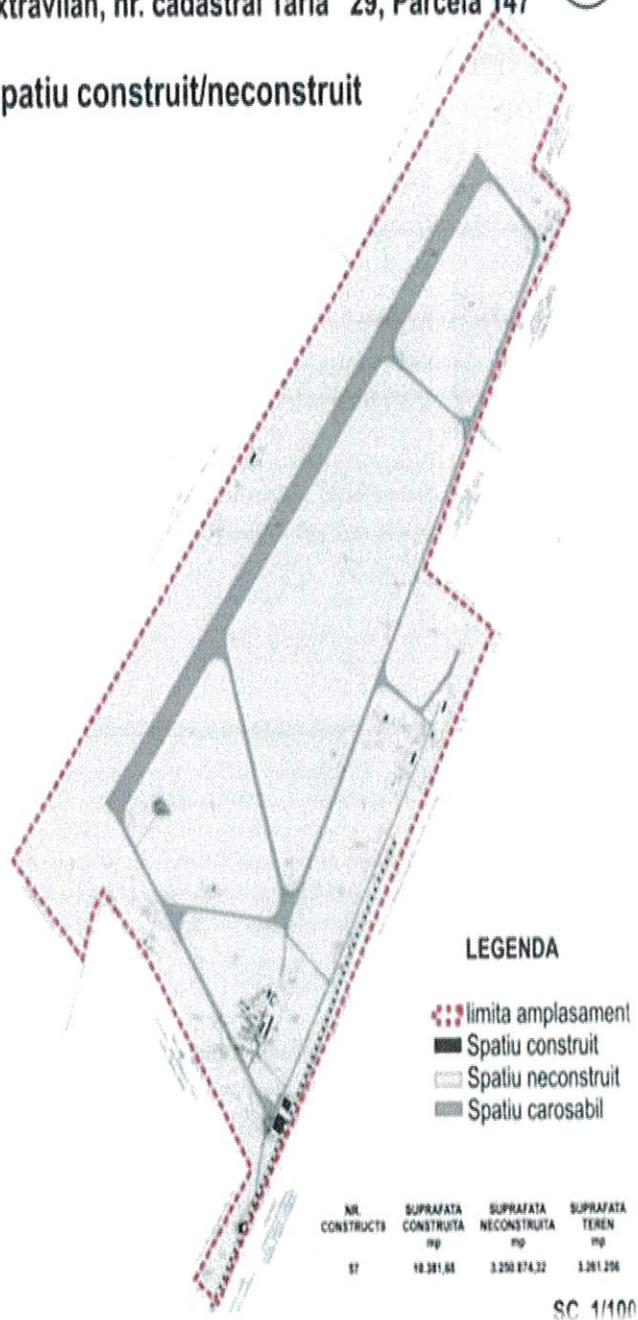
Tarla 29, parcela 147, nr. cadastral 251, Spațiu construit – neconstruit
